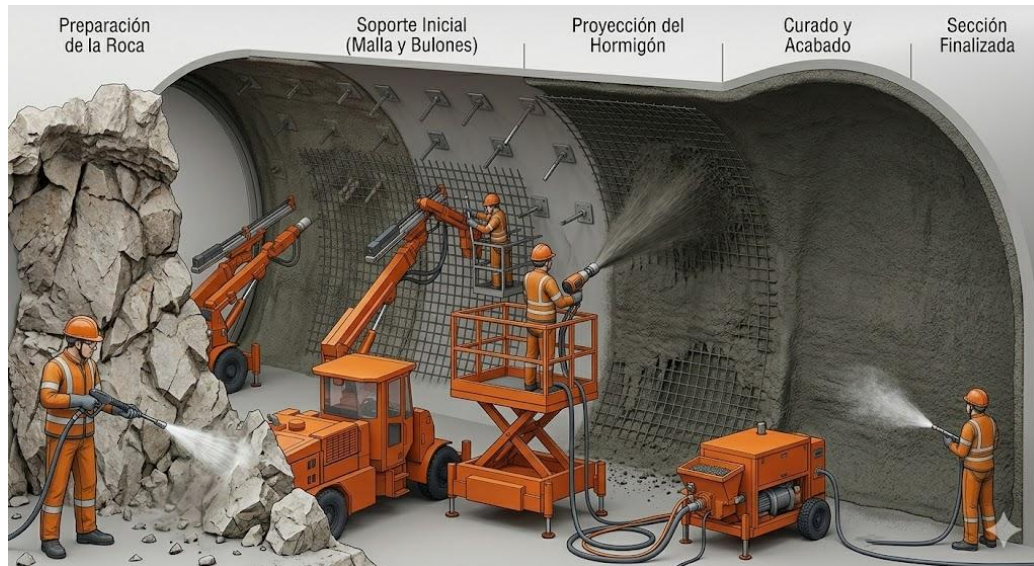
Proceso constructivo del hormigón proyectado. Fuente: Elaboración propia.
